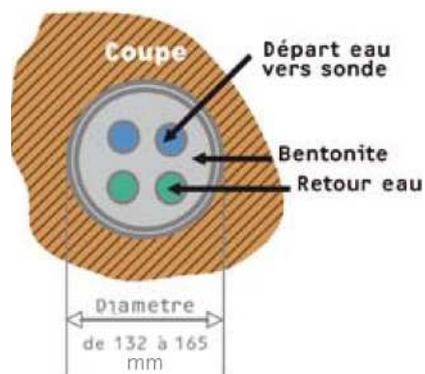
Coupe horizontale d'un capteur géothermique enterré (Source : BRGM)
